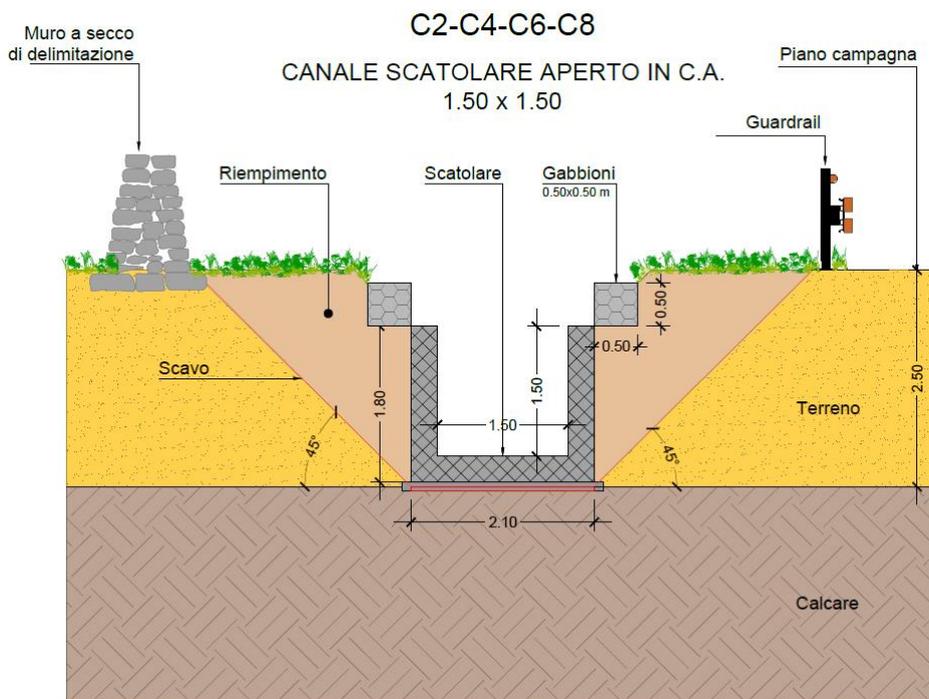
Sezione tipo del canale delimitato da muretto a secco e staccionata
